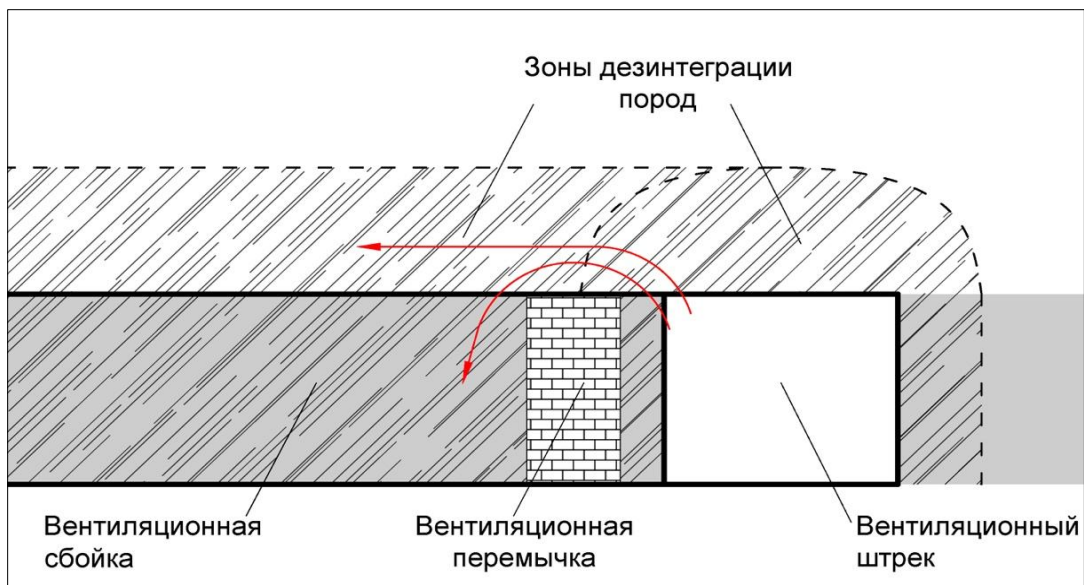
Утечки воздуха на сопряжении воздухоподающей выработки и вентиляционной сбойки [41]
